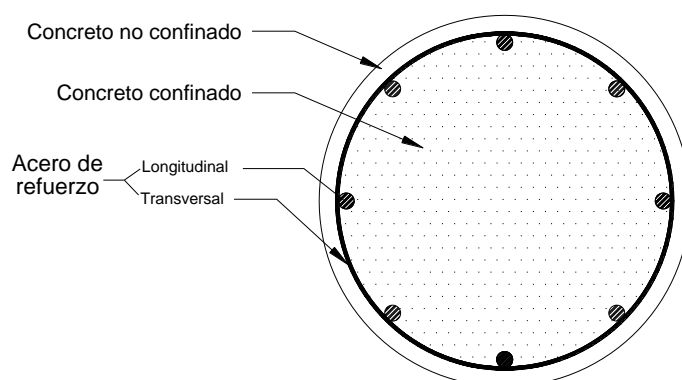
Materiales componentes de la sección transversal de una columna de concreto reforzado.
